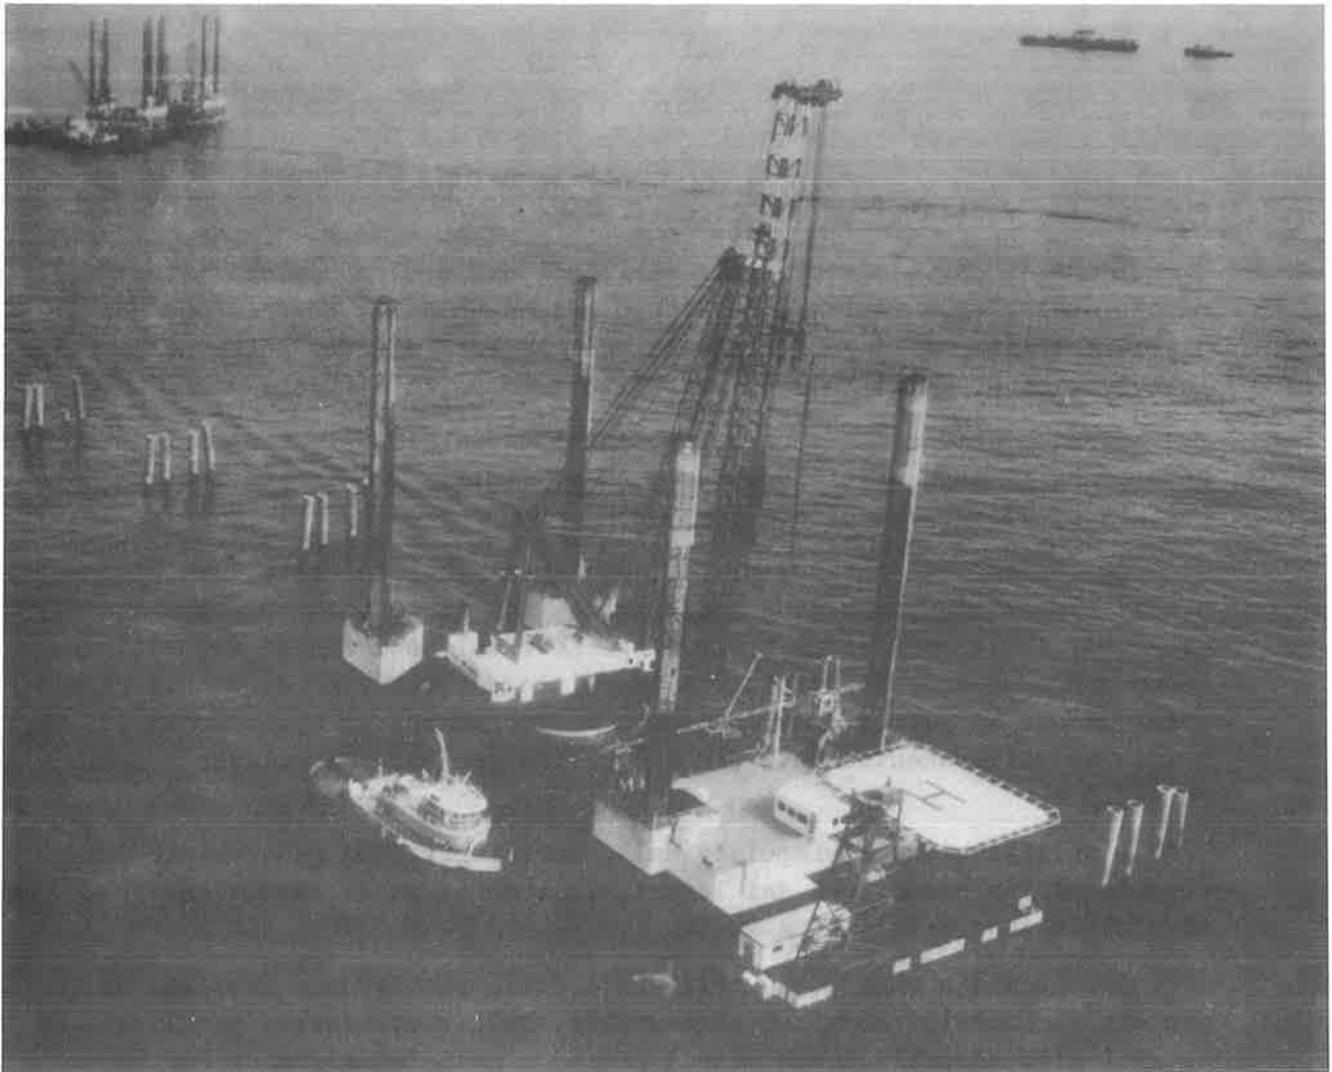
Piattaforma flottante autosollevante (pali battuti)
